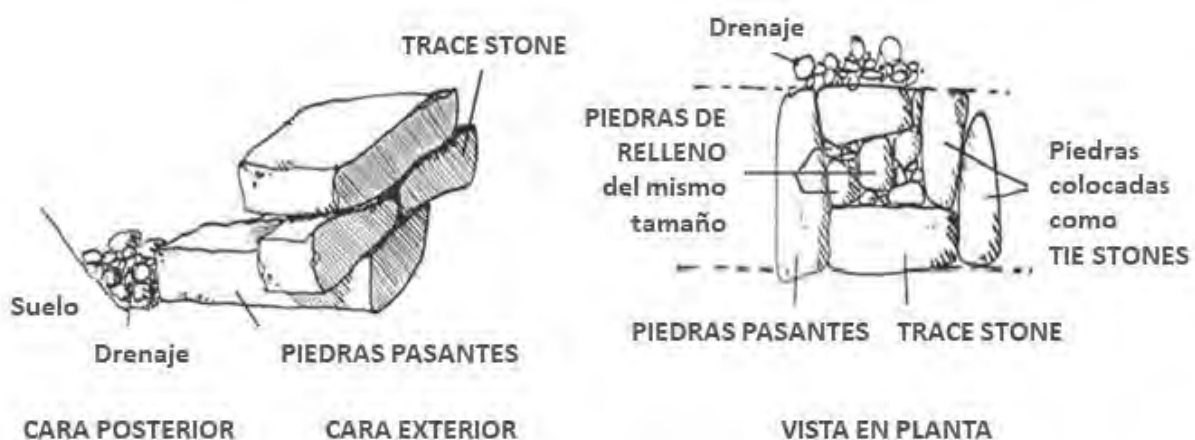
Vista transversal y en planta de algunas de las categorías de las piedras
